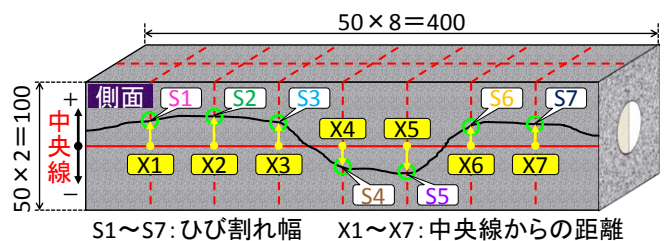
ひび割れ幅・発生位置測定概要図(単位: mm)
